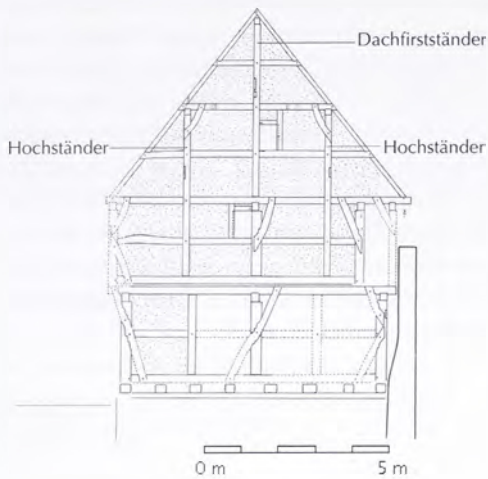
Hochständergerüst mit Dachfirstständer auf Erdstock, Herbolzheim (Lkr. Emmendingen), Hauptstr. 105 (Kirchplatz), 1462/63 (d).
